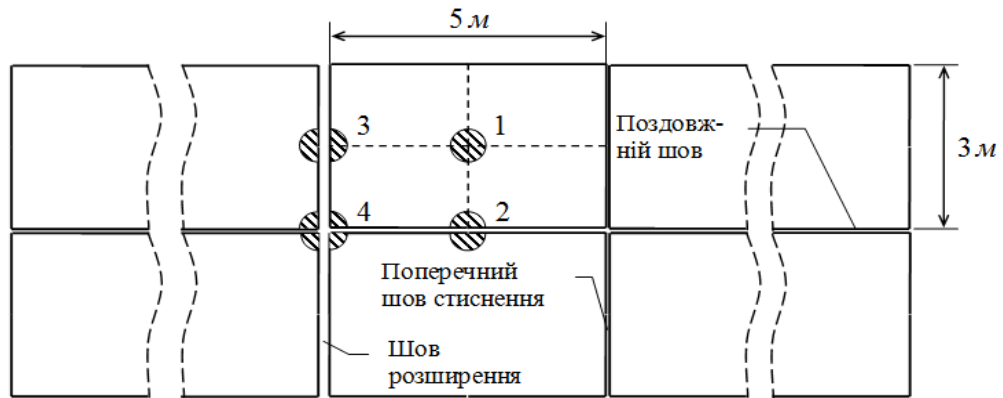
Геометрична схема цементобетонного покриття
